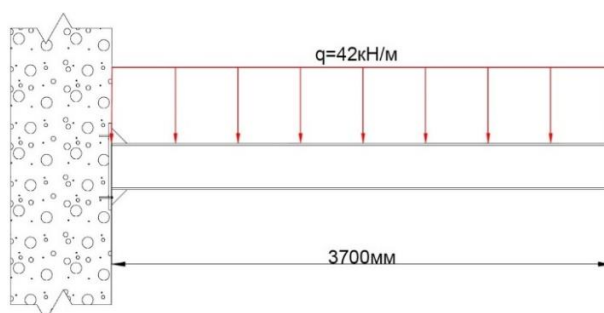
Балка антресоли под расчетной нагрузкой
